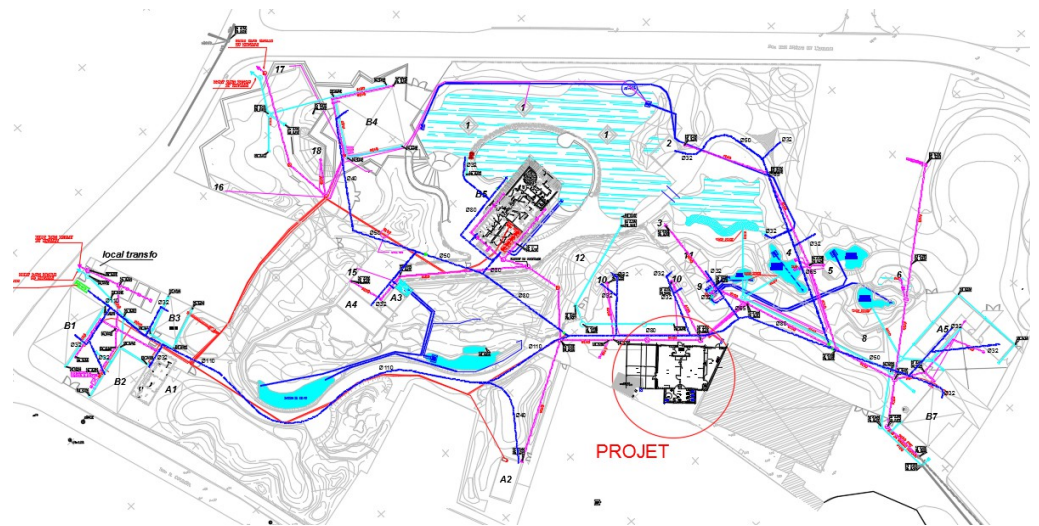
Plan masse du site du parc zoologique. Plan fourni par la CUD
